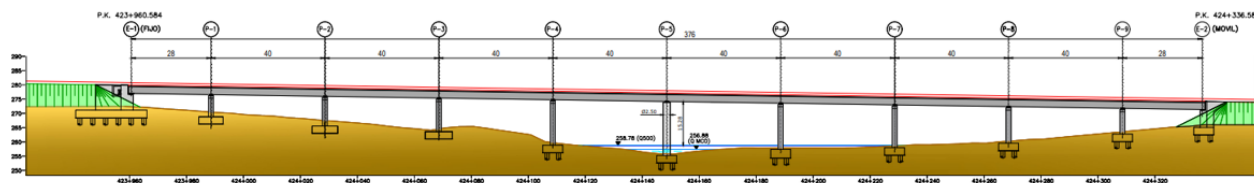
Alzado del Viaducto sobre la Rambla de Galián
